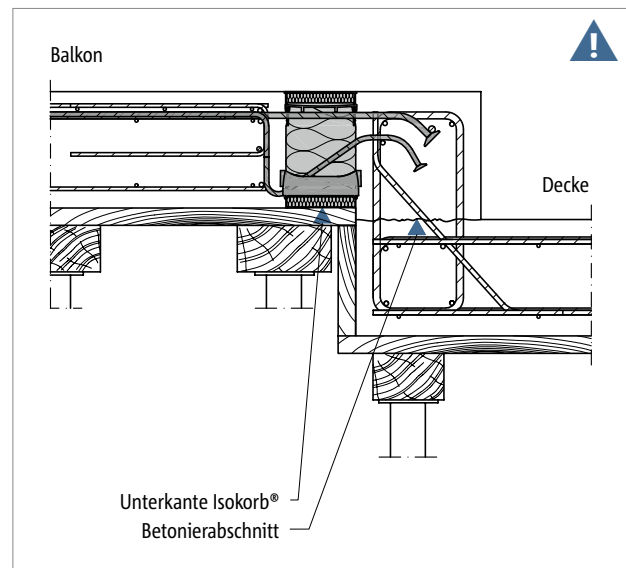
Schöck Isokorb® XT Typ KL-O: Ortbetonbalkon mit Höhenversatz nach oben
